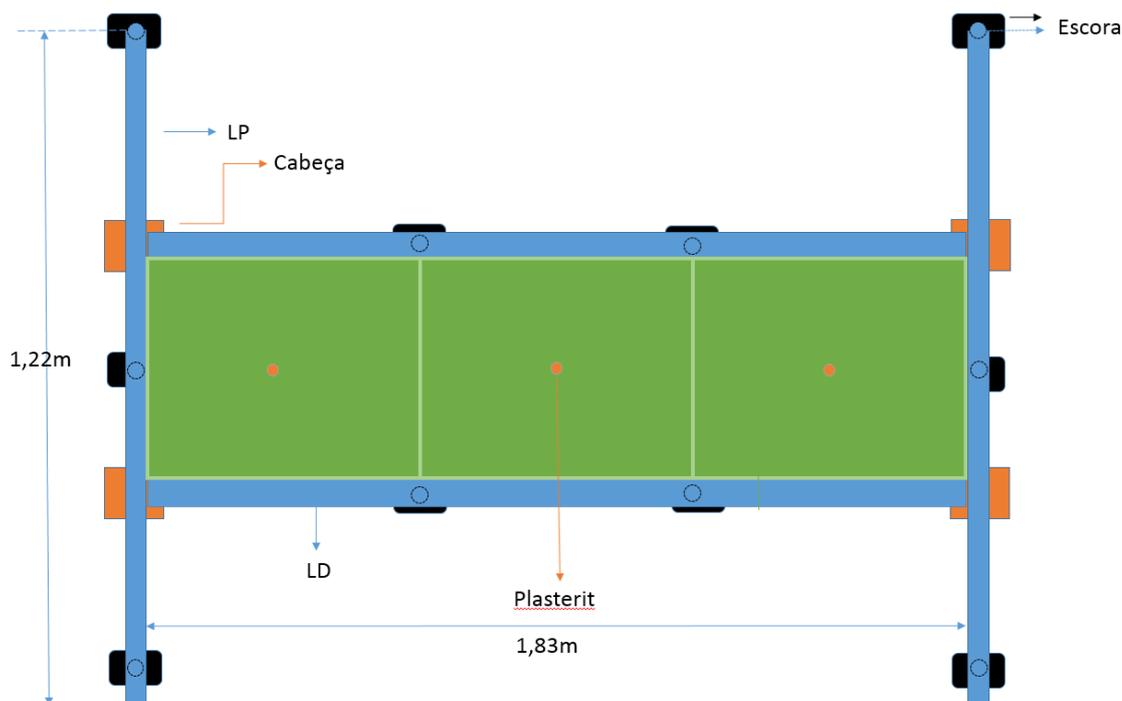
Vista em planta de *Plasterits* sobre o CIMP.
